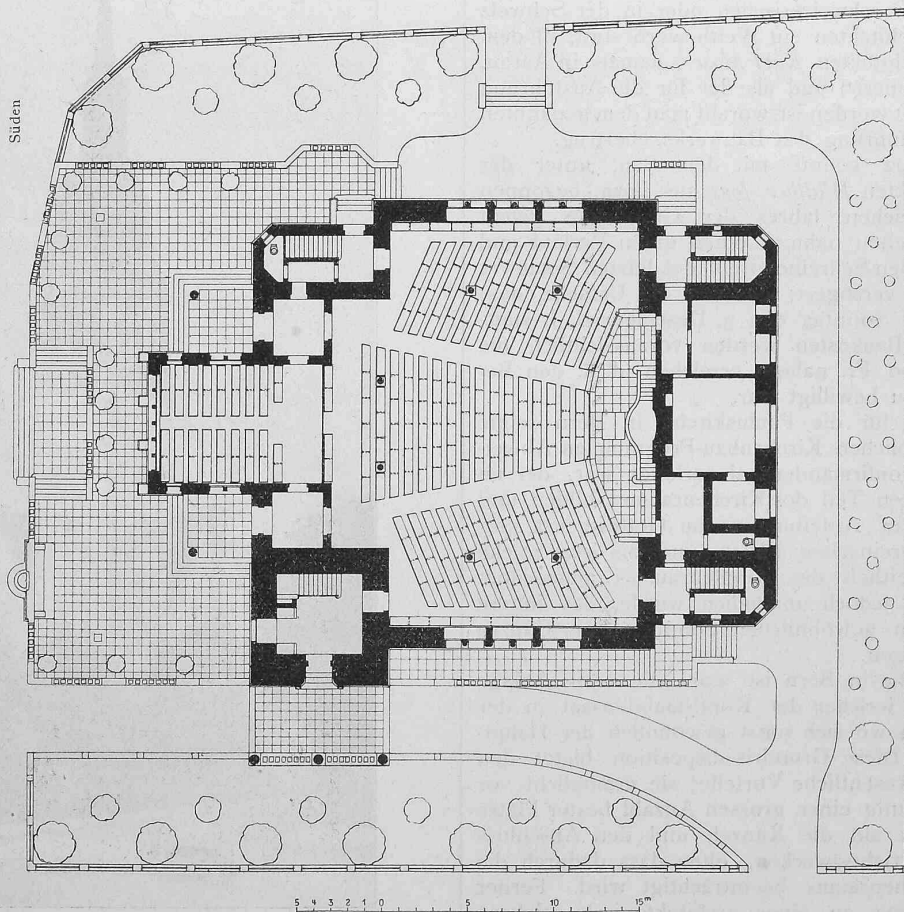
Grundriss vom Erdgeschoss. — Masstab 1 : 400.
